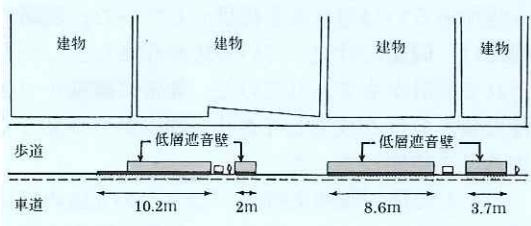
低層遮音壁 (国道4号東京都足立区南千住) 平面図
